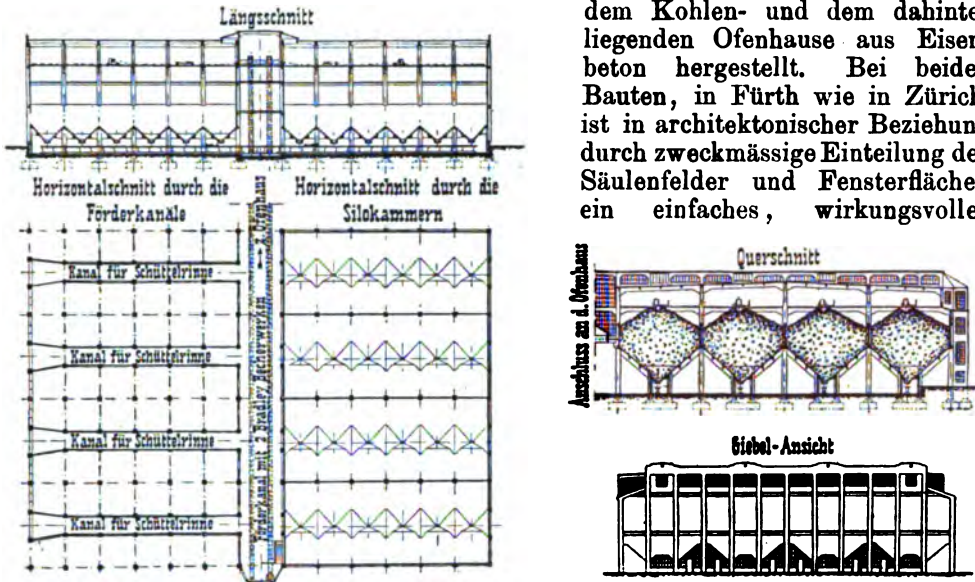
752. Kohlenlagerhaus in Eisenbeton für das städtische Gaswerk in Zürich-Schlieren (~ 1:1000).
